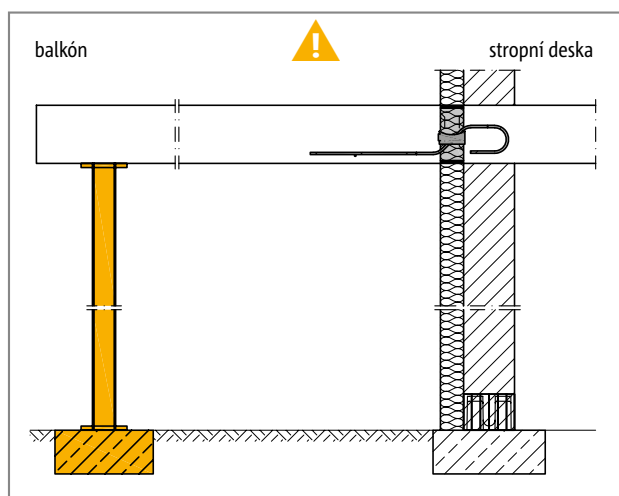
Schöck Isokorb® T typ QL/QP: Isokorb® T typ QL/QP zabudovaný ve filigránové desce
